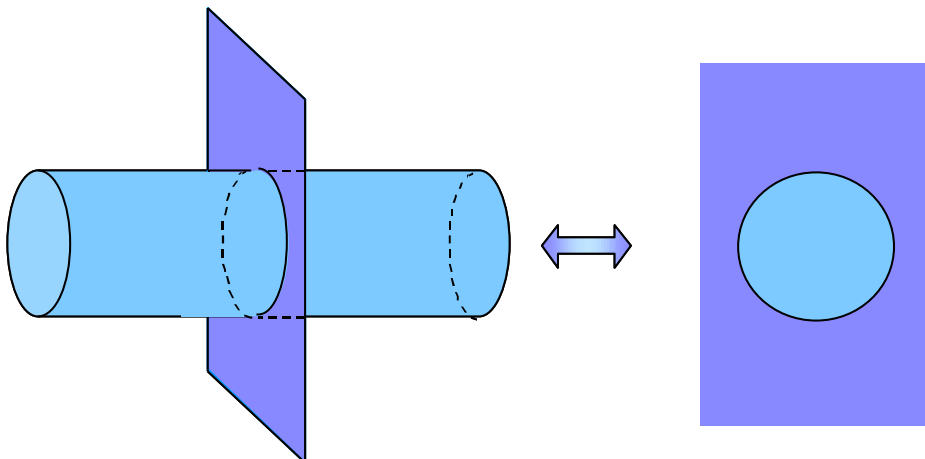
Plan d'étude d'une galerie en déformations planes
